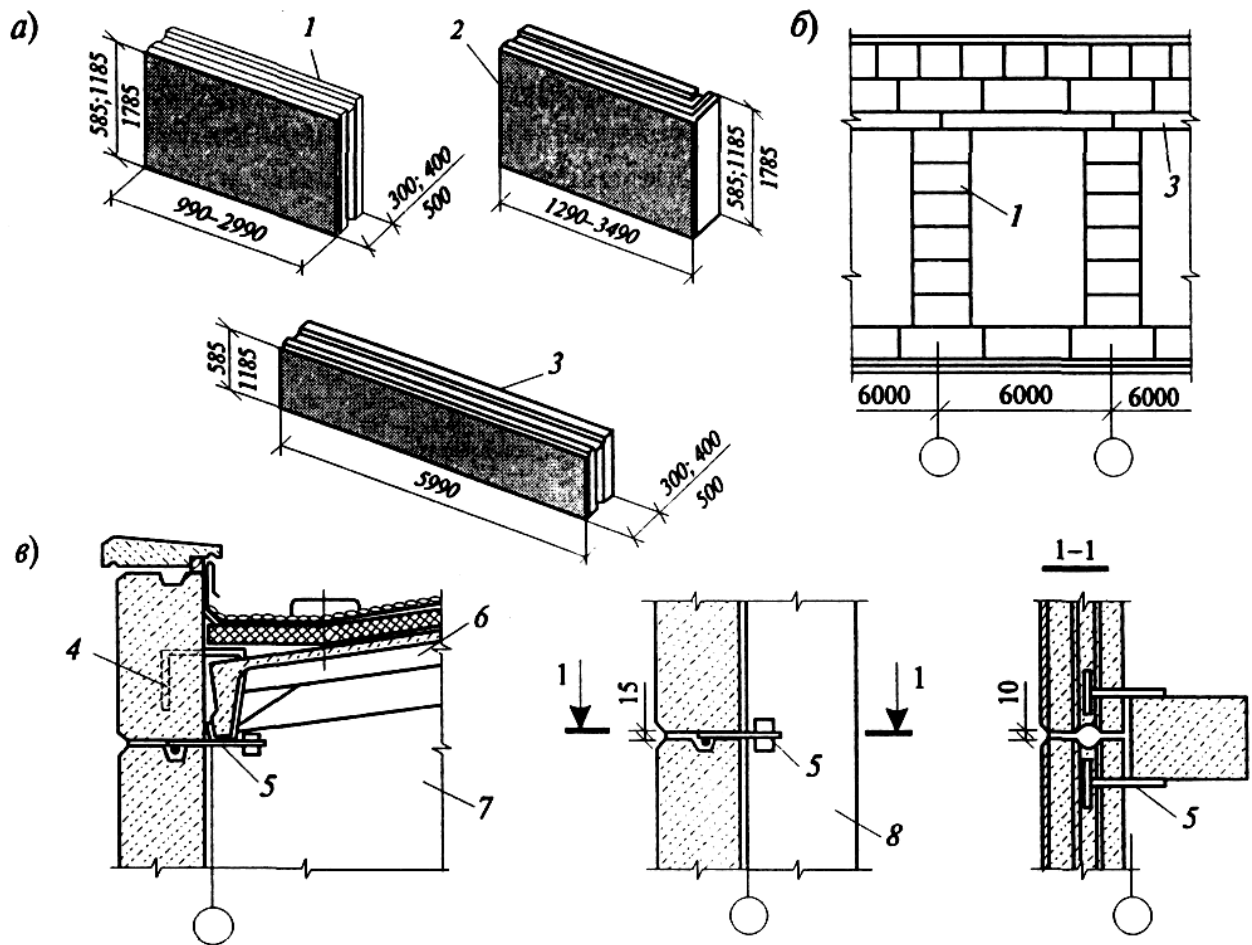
Стеновые крупные бетонные блоки:
